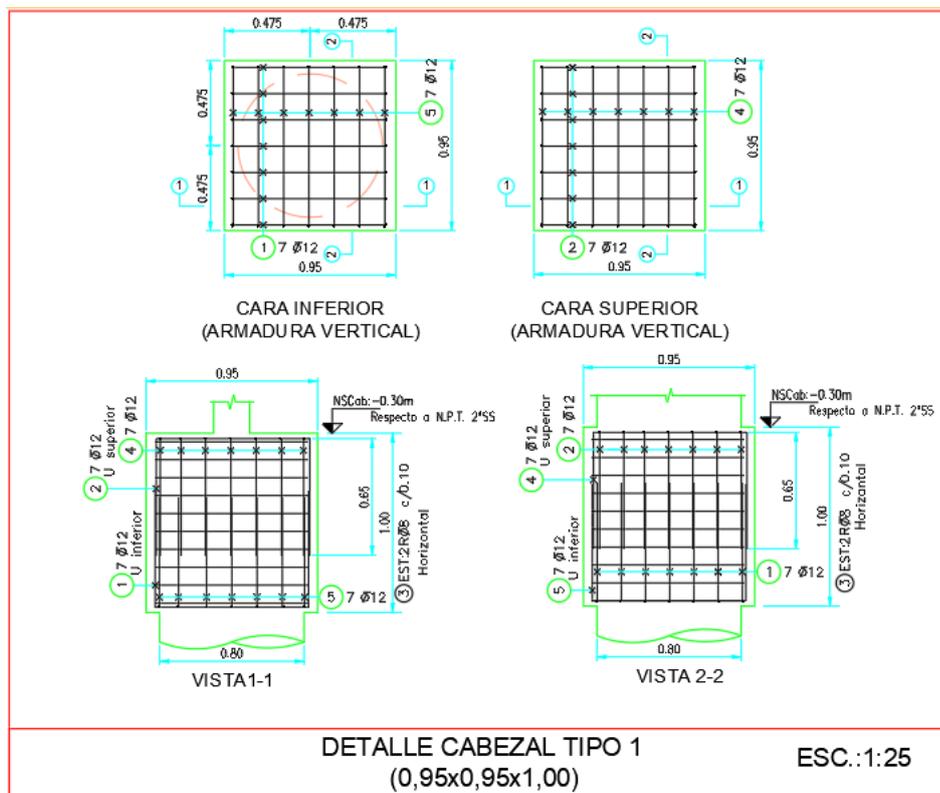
Detalle del Cabezal tipo 1. Corte 11 y 22.
